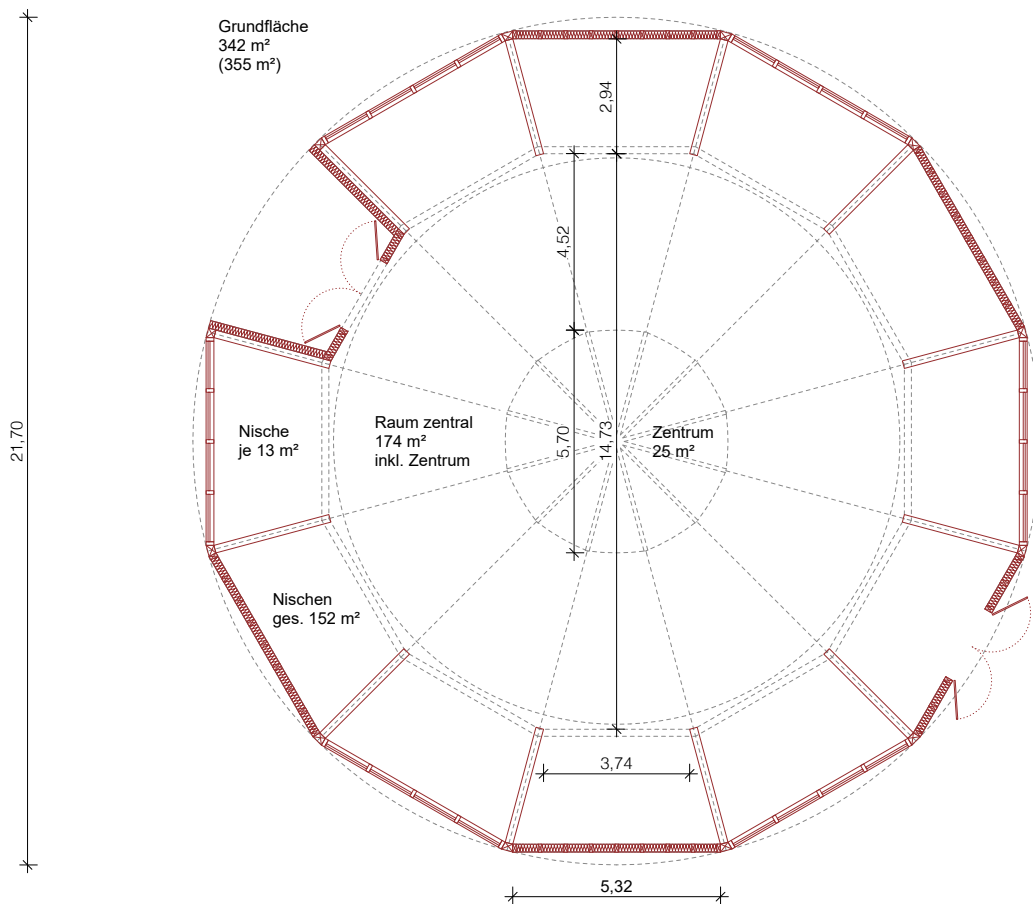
Grundriss des Rundbaus (schwarz: Schalungselemente, rot: ergänzende Bauteile)
